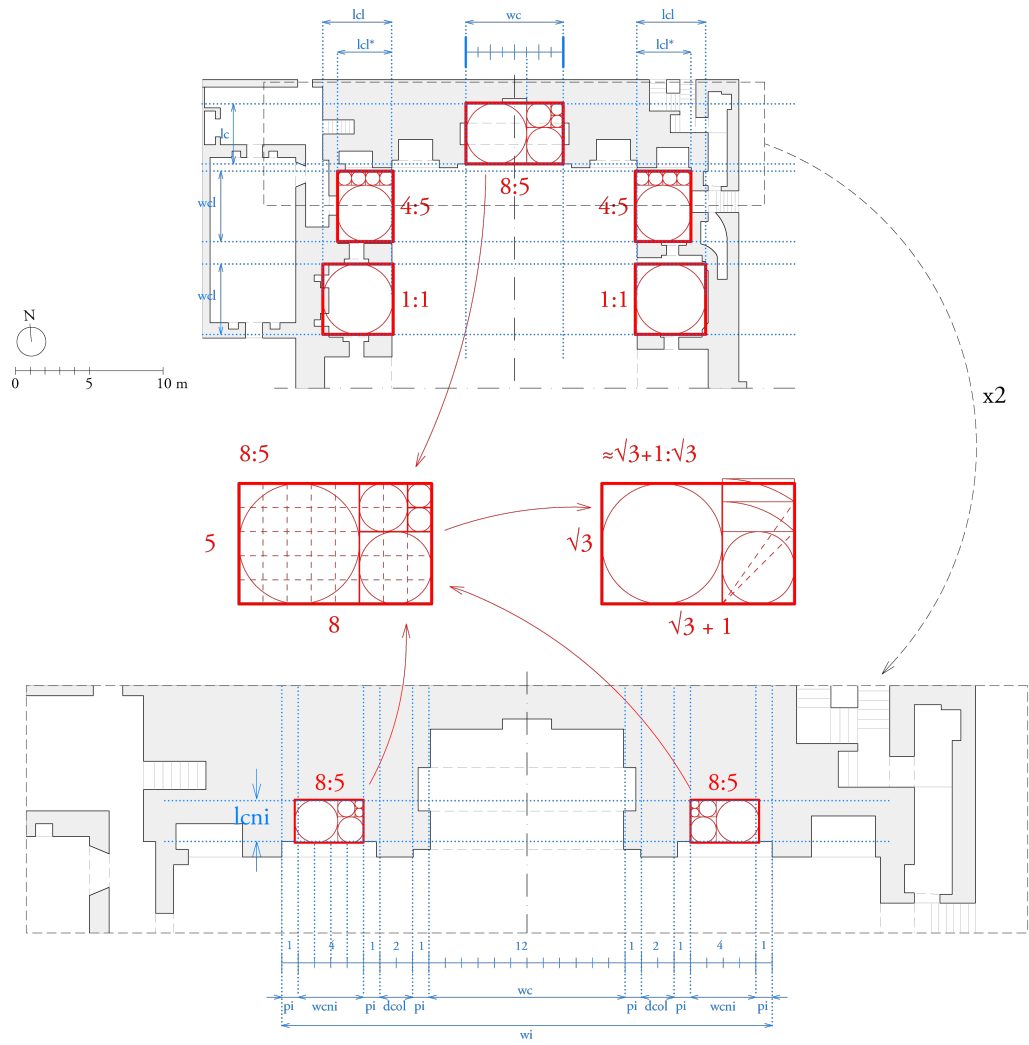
Análise de proporções da planta da igreja de São Roque. Em cima, extracto do topo planta ilustrando as proporções da capela-mor e capelas laterais. Em baixo, extracto da cabeceira, ilustrativo das proporções e parâmetros relativos à abertura de nichos.
